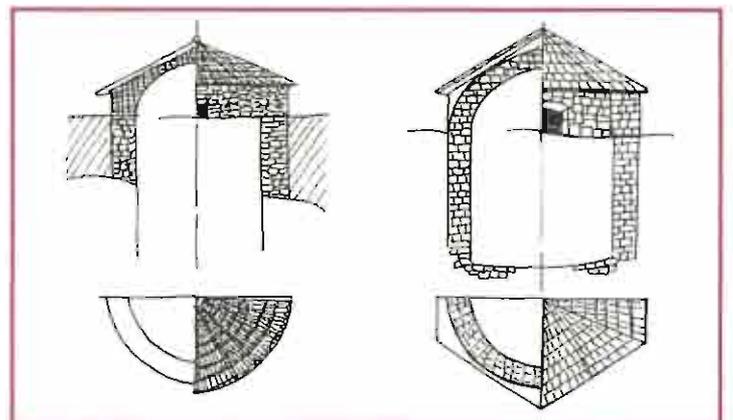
Pozos de cerramiento con cúpula semiesférica de mampostería y techado de teja o lajas de piedra
